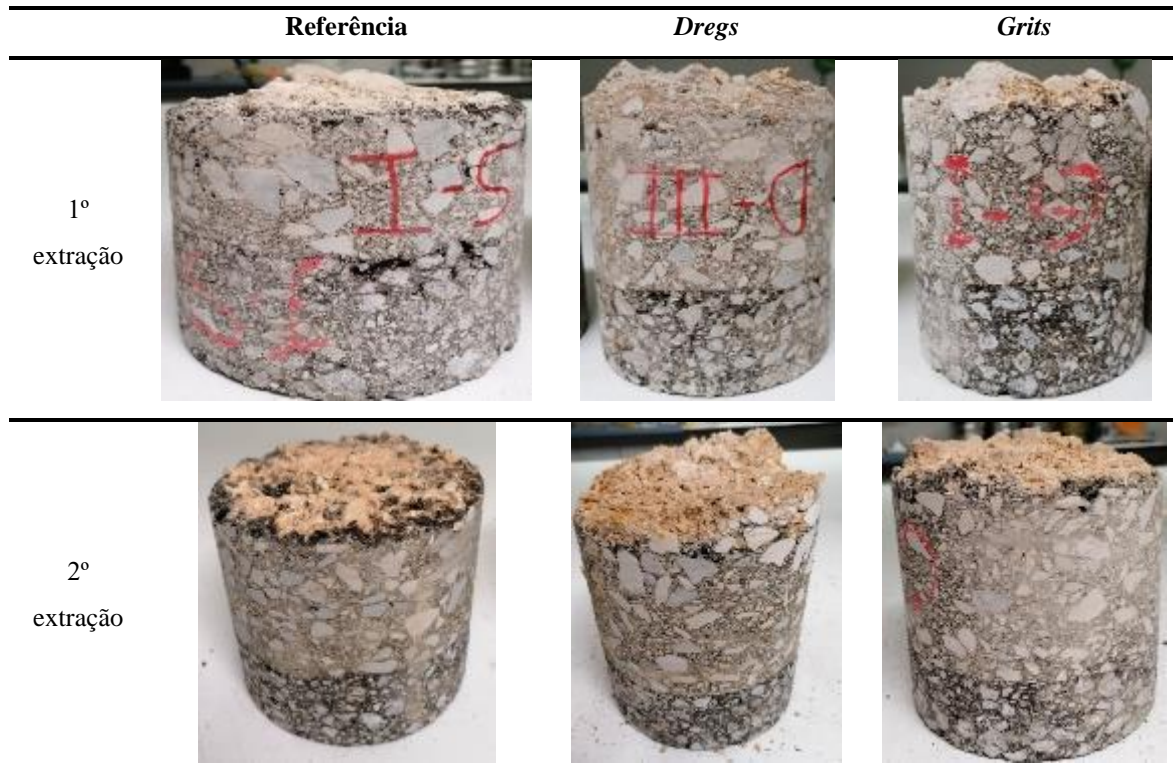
Estrutura do pavimento das camadas ligadas (carotes).
